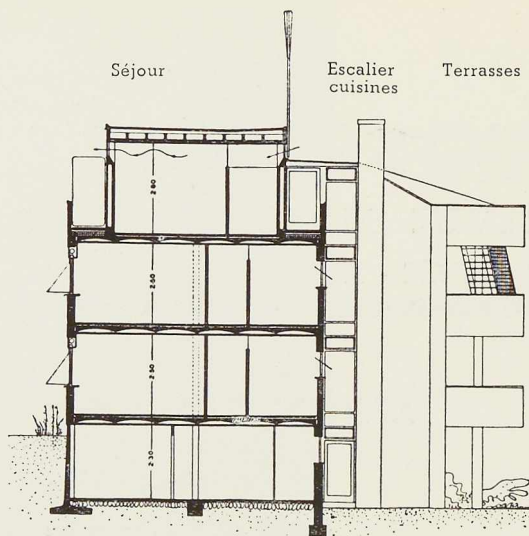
Coupe transversale montrant la disposition de la cage d'escalier et de la cuisine accolées aux locaux de séjour.
